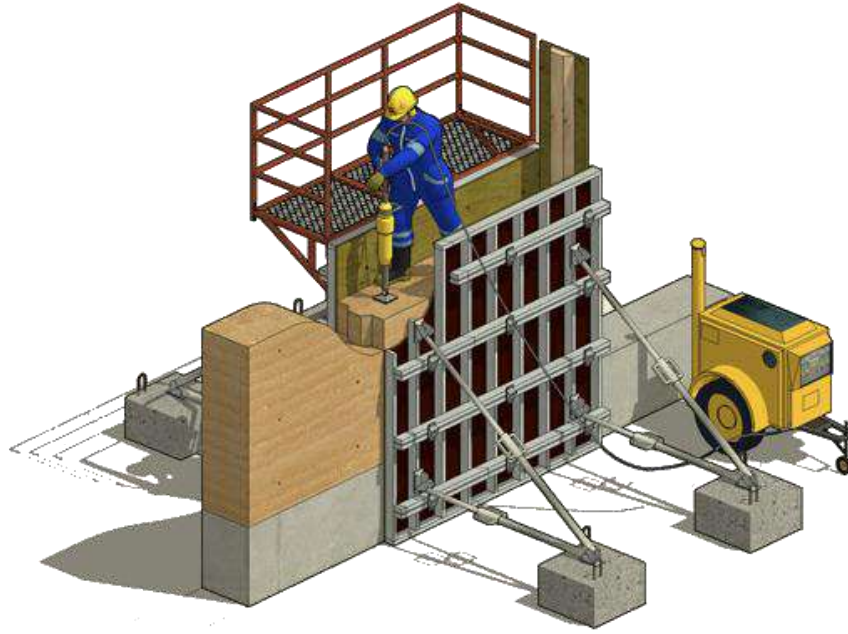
Sistema de muros de tapial a base de barro. Fuente: (tieRAH, 2014)
